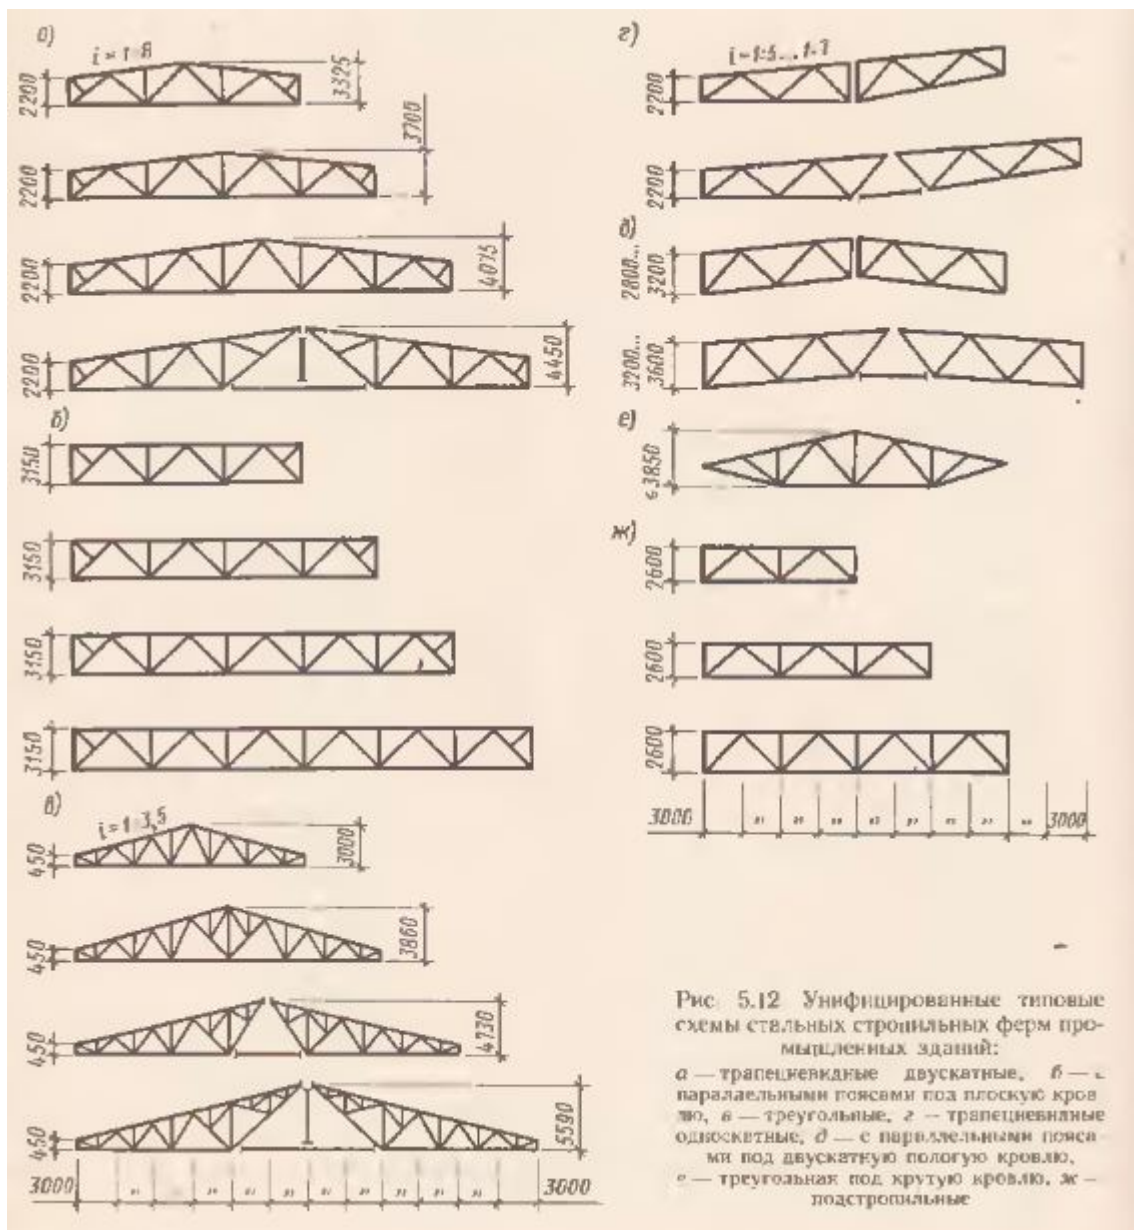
Унифицированные типовые схемы стальных стропильных ферм промышленных зданий:
